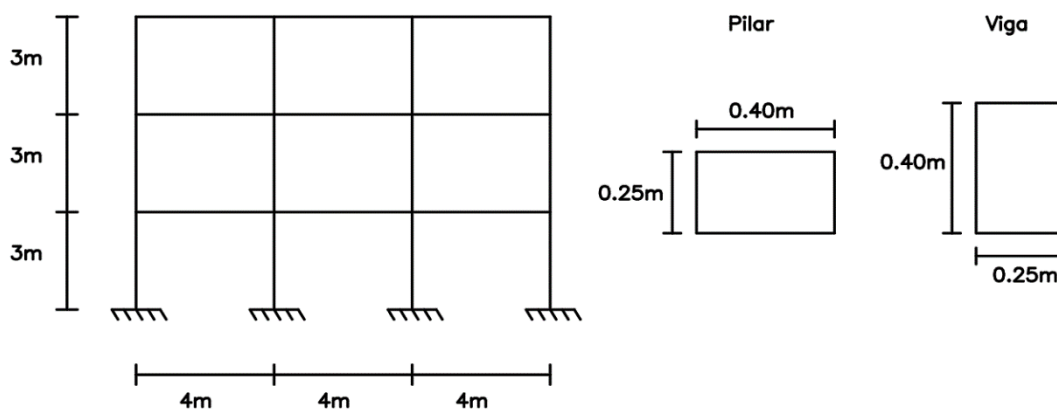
Modelo da estrutura do pórtico com a representação da geometria e dimensões das vigas e pilares. Adaptado de [11].
